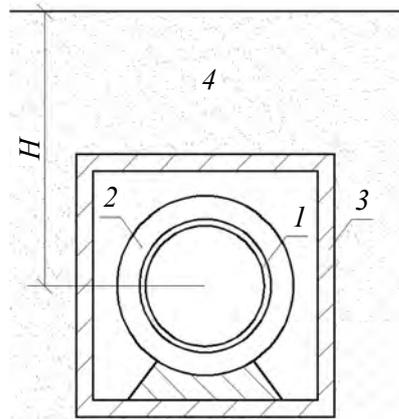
Схема расположения трубопровода в непроходном канале подземной прокладки: H – глубина залегания к горизонтальной оси; 1 – металлическая стенка трубы; 2 – слой изоляции; 3 – железобетонная стенка канала; 4 – грунт
